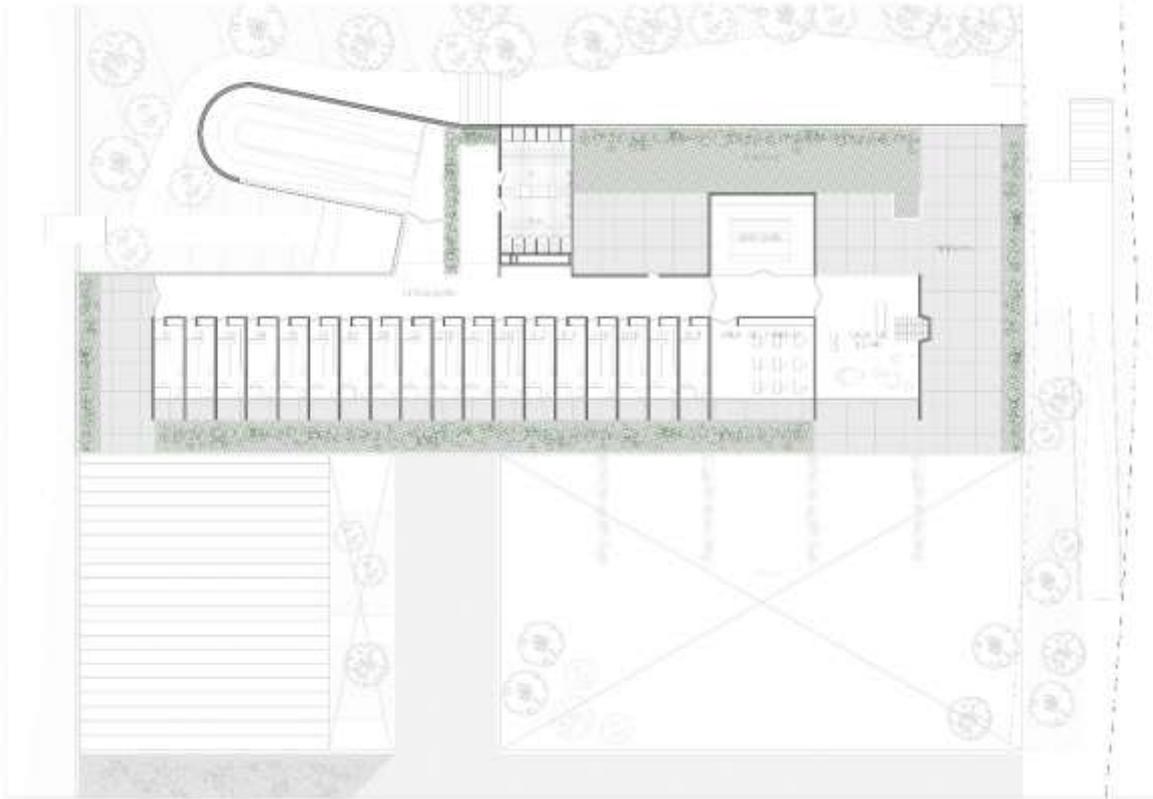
/ Planta P2 N+31,70.10, 2024 Revisitando Lamina 01 1958 A. Pereda
